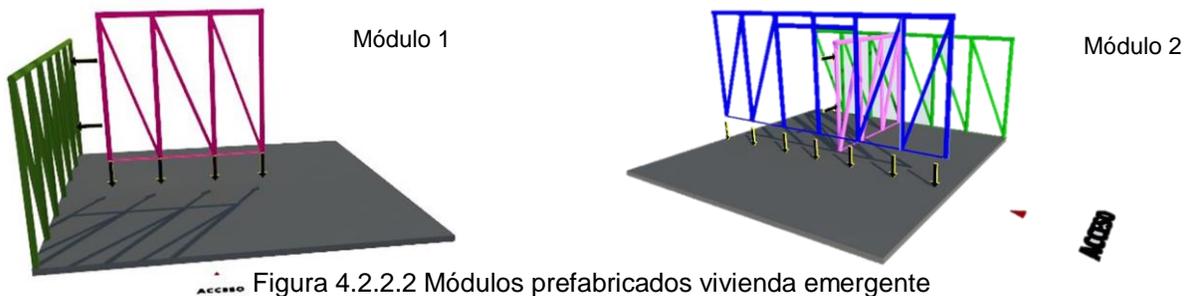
Módulos prefabricados vivienda emergente
